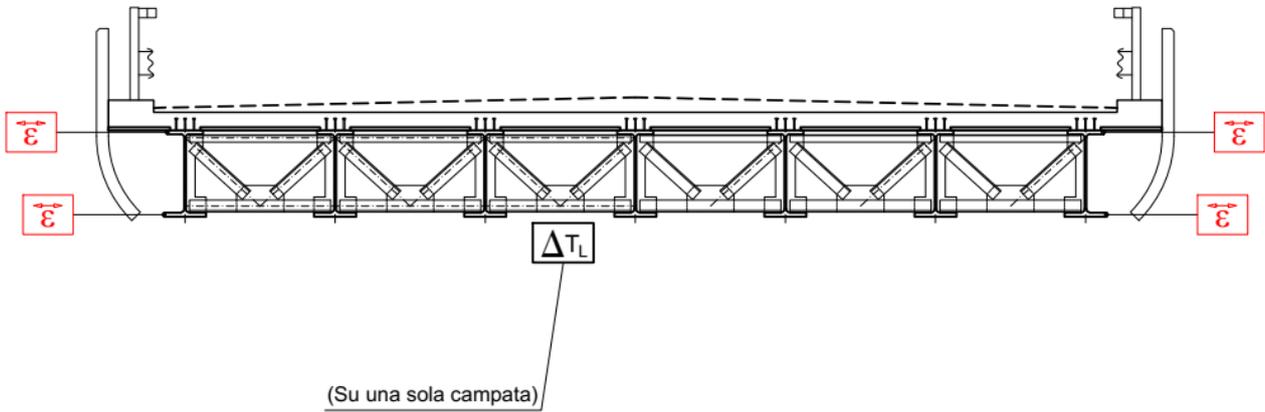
Ubicazione sensori su impalcato sezione a 7 travi (sezione trasversale viadotto Rampa bidirezionale)
